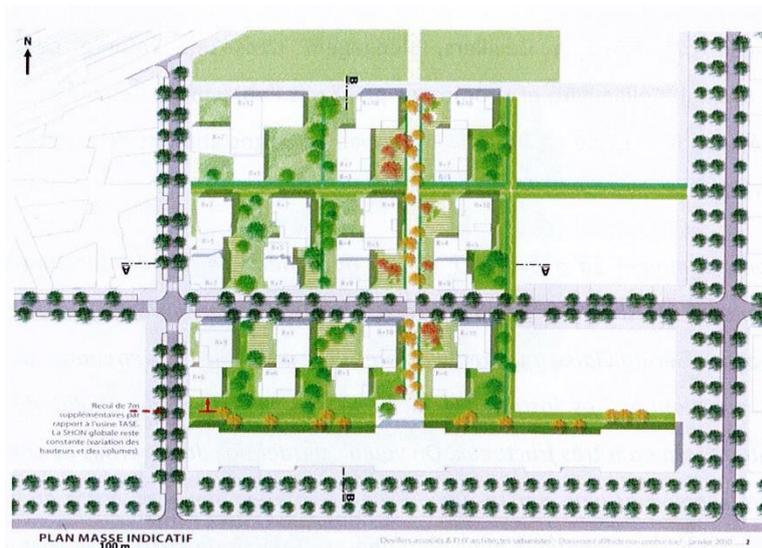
Plan masse proposé par Boufonds Marignan en 2010. (Source : Mission Carré de Soie)
